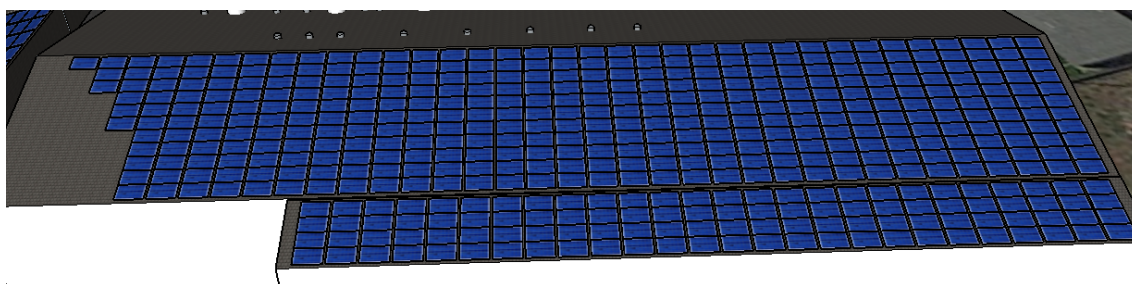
Instalação dos painéis no telhado 2 e 15.
